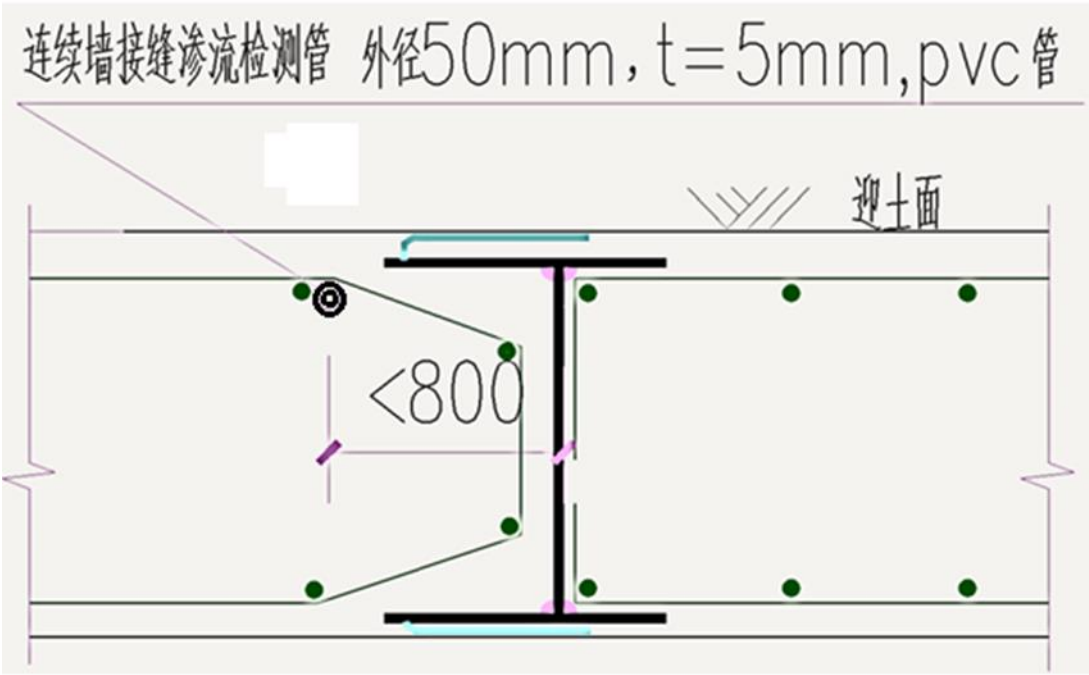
地连墙钢筋笼工字钢接头渗流检测 PVC 管布置平面图
